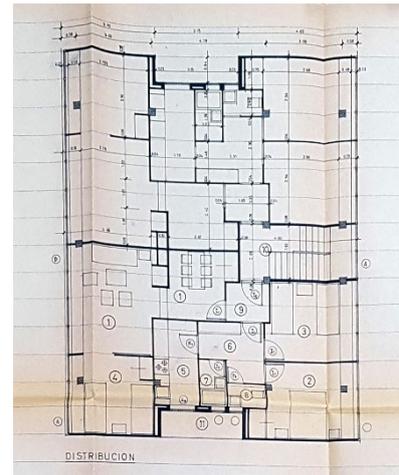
Planta Distribución B-3-3-E. 1964. Fuente: Archivo Municipal da Coruña
